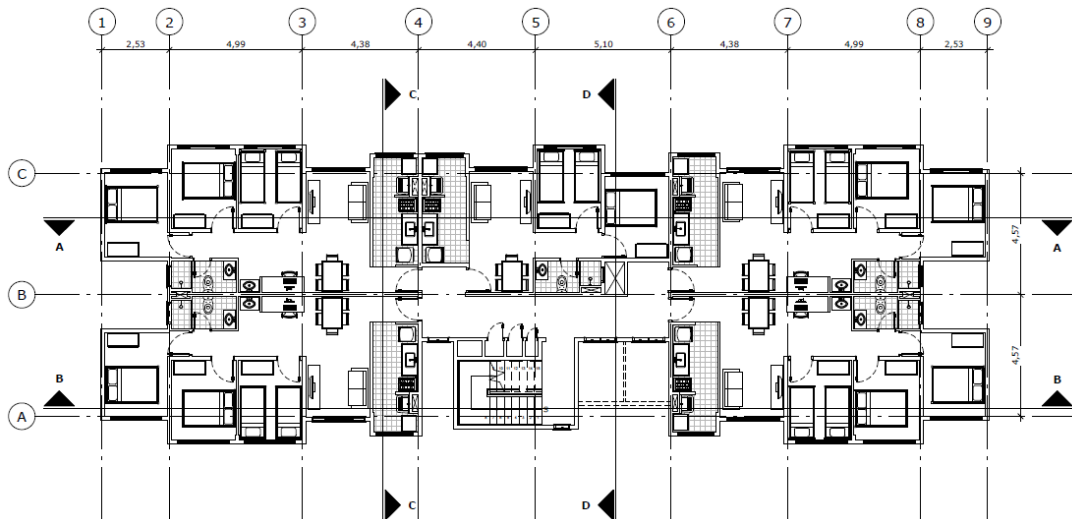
Planta do edifício com 5 pavimentos e 3 dormitórios. Fonte: Levisky e Ferreira (2009)
